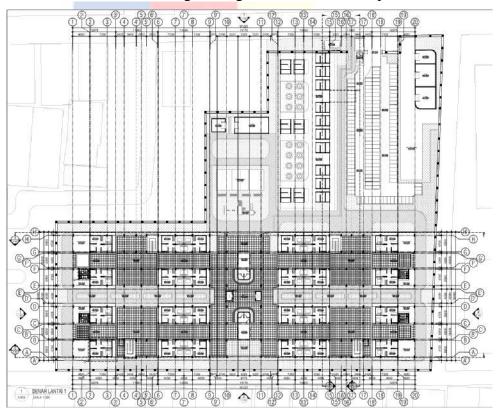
Site Plan Rusunawa Cipinang Muara
